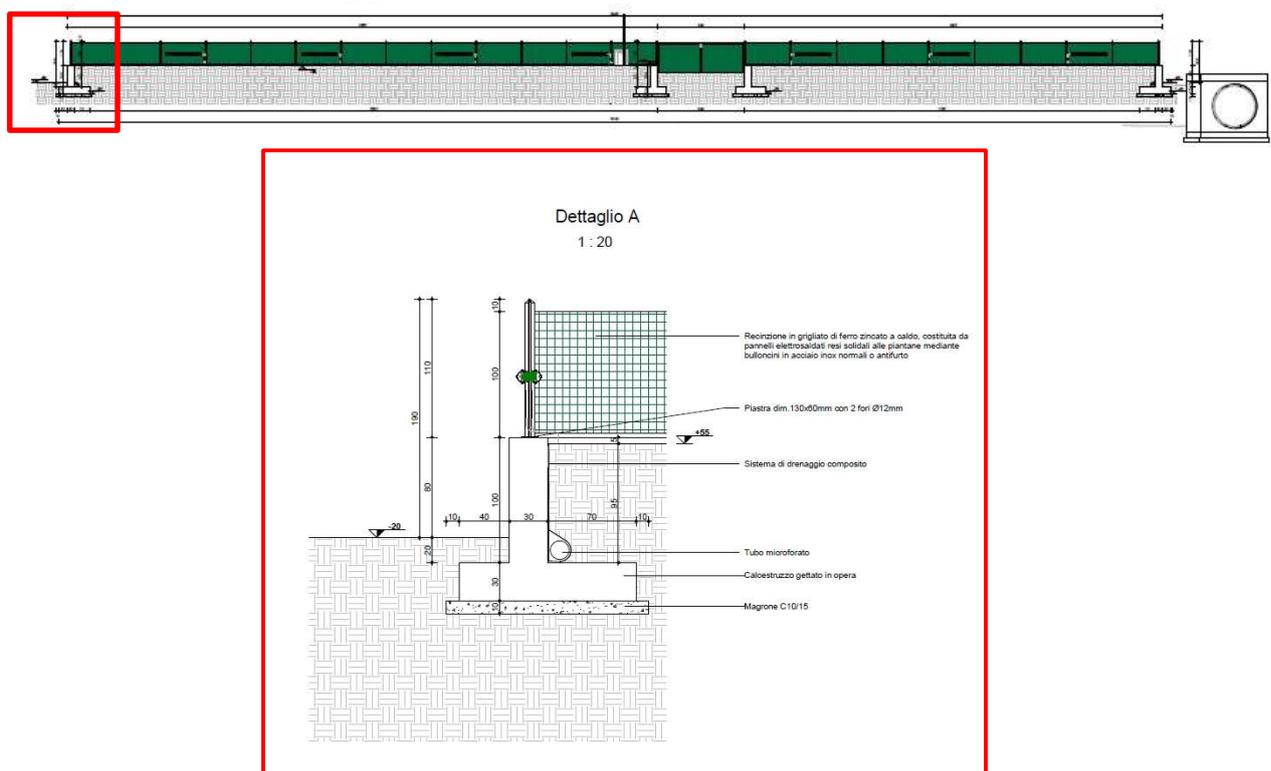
VRA – sezione longitudinale e dettaglio fondamenta
